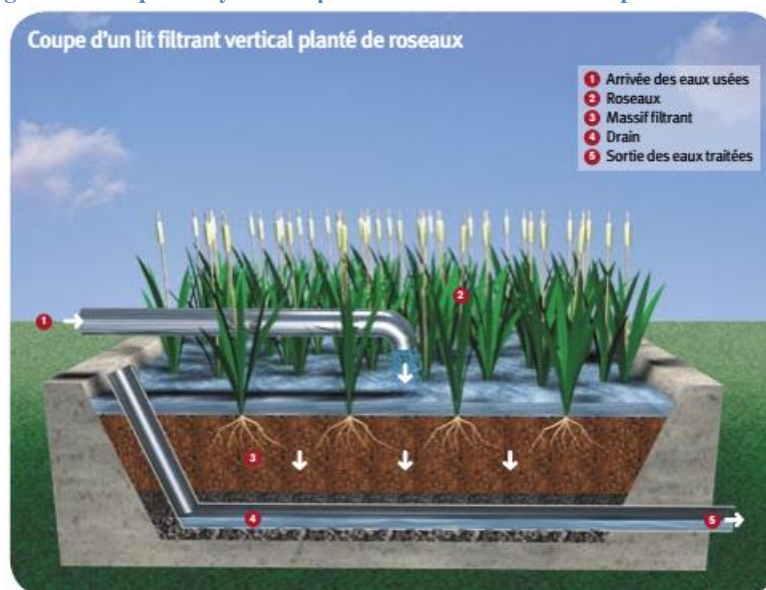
coupe d'un lit filtrant vertical planté de roseaux
